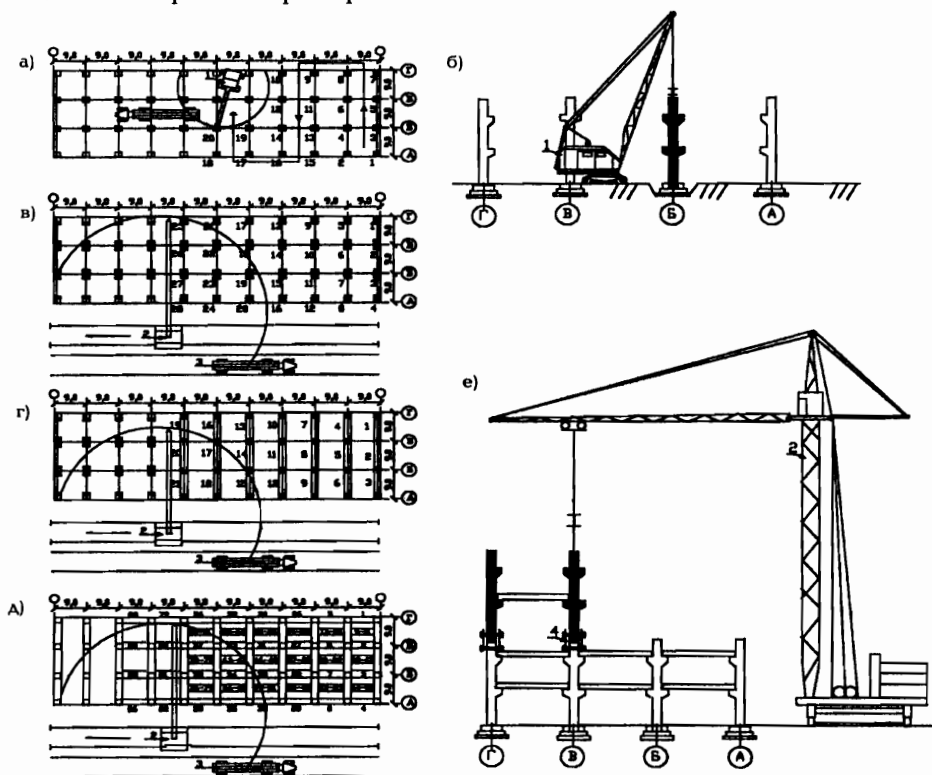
Технологические схемы монтажа каркаса здания стреловым и башенным краном: а, б – монтаж двухъярусных колонн в стаканы фундаментов; в – технологическая последовательность монтажа колонн 3...4 этажей, г, д – ригелей и перекрытий; е – схема монтажа двухъярусных колонн с применением одиночных кондукторов: 1 – стреловой кран; 2 – башенный кран; 3 – транспортное средство; 4 – одиночные кондукторы
